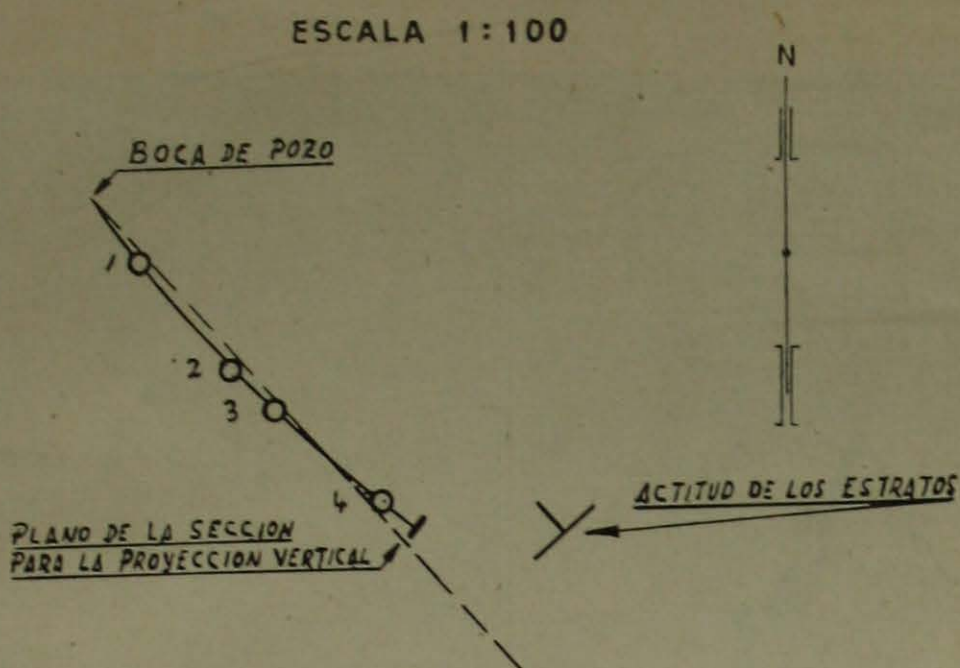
Perforación B6; proyección horizontal; escala 1:100.
